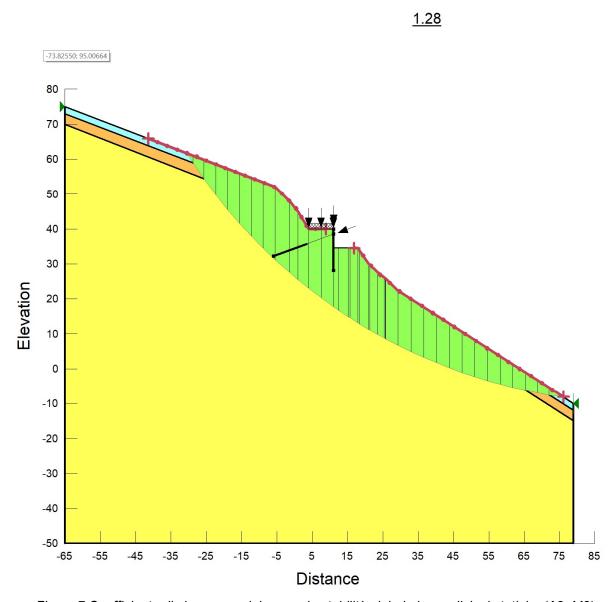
Coefficiente di sicurezza minimo per la stabilità globale in condizioni statiche (A2+M2)
